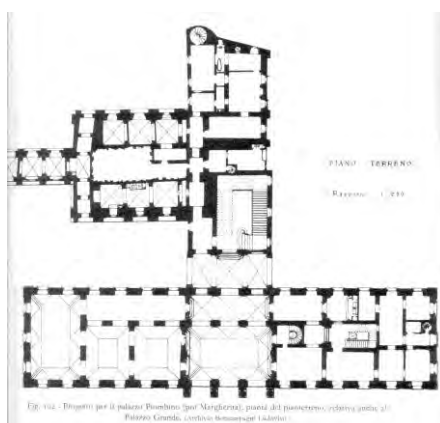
palazzo Piombino pianta piano terreno da A. Schiavo
